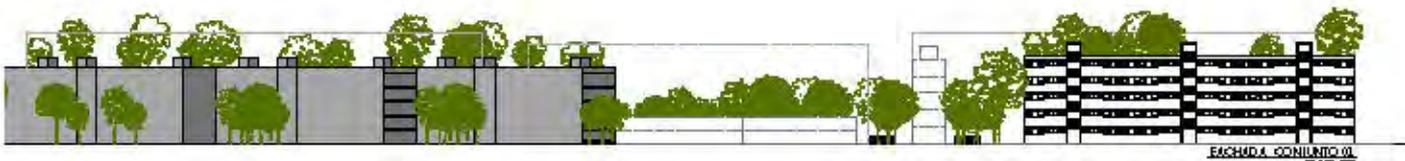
Alzado de conjunto de cara a Av. Tlalpan
